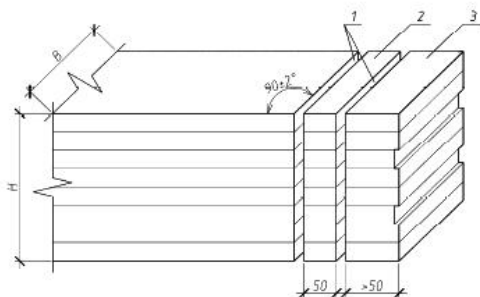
Схема выпиливания заготовки для образцов на послойное скалывание:
